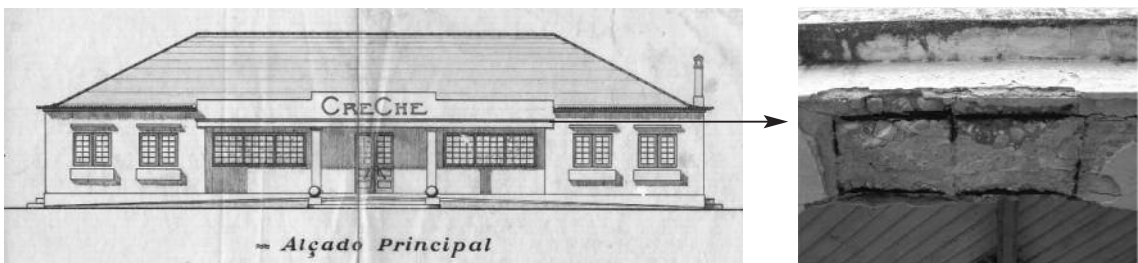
Alçado principal do projecto da Creche e foto da viga da entrada (foto: Alice Ruano).
